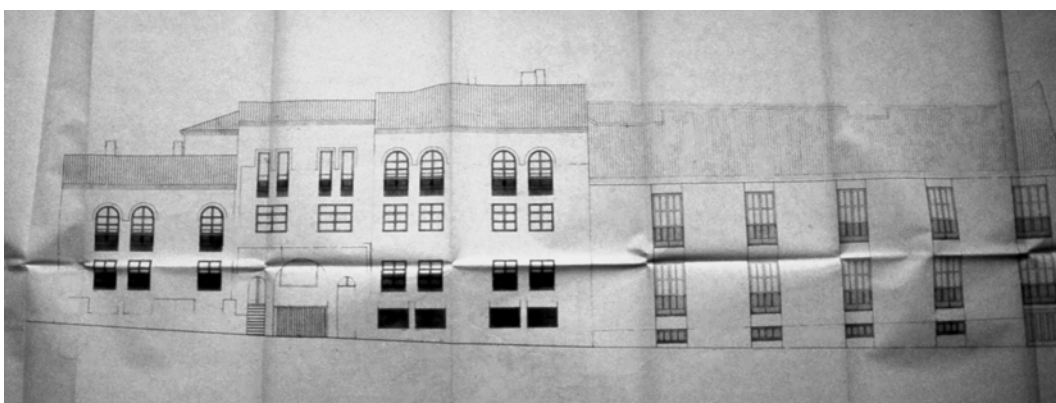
Biblioteca de Santa María de los Ángeles: fachada a calle de las Mazas, por J. E. Díez y R. Pérez, septiembre de 1982.
